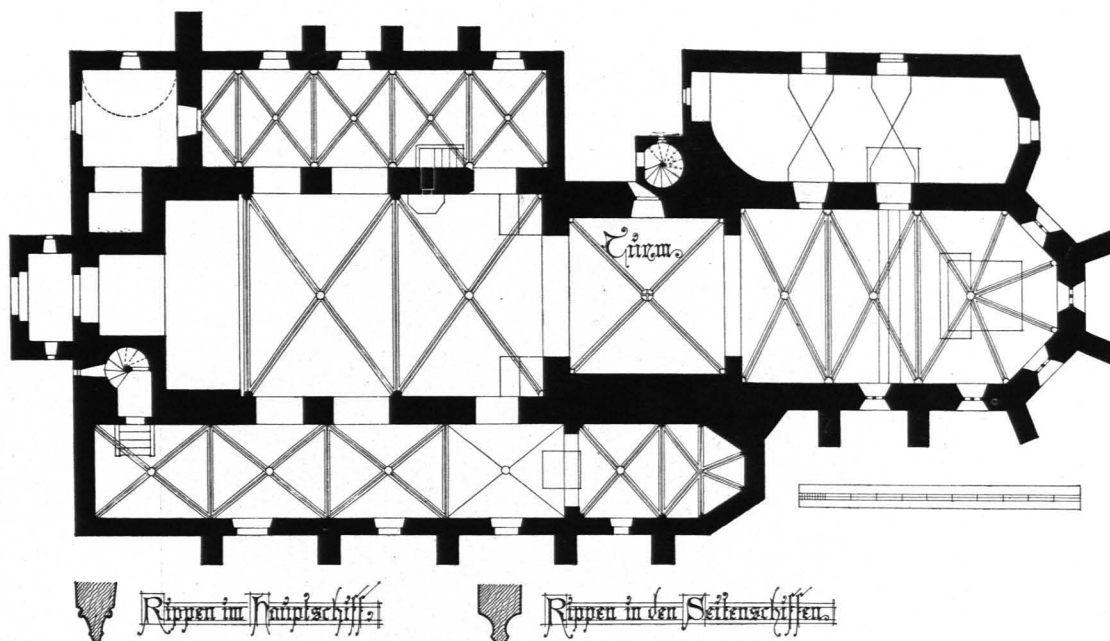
Alt-Pölla, Pfarrkirche, Grundriß 1 : 300 (S. 161)
